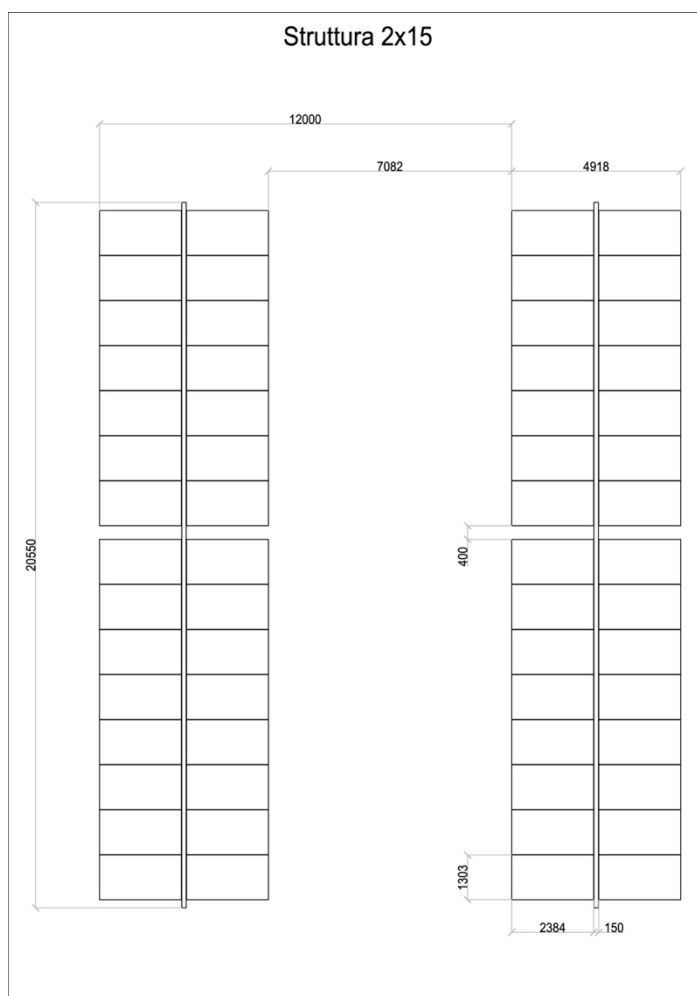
Vista in pianta delle stringhe fotovoltaiche previste a progetto
